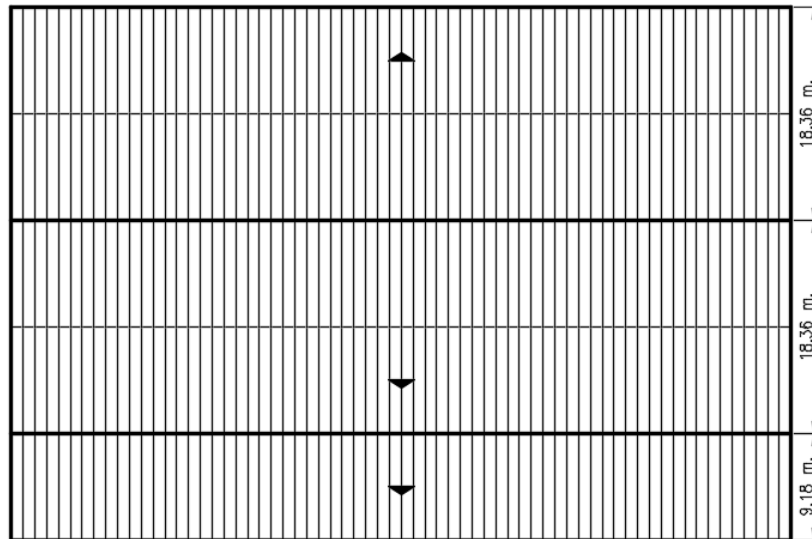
Paneles sobre los faldones de cubierta, vista proyectada en planta en verdadera magnitud.
